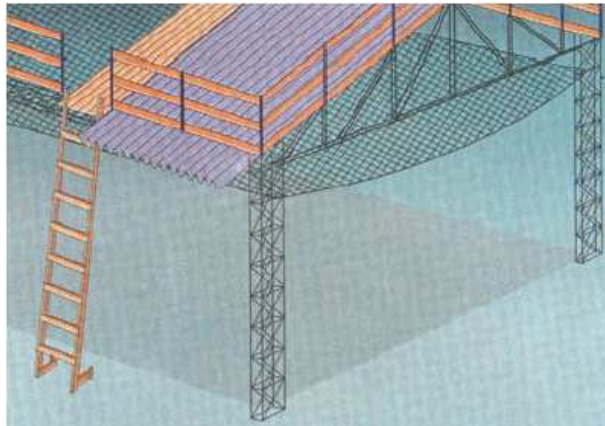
Construção de telhados com a utilização de EPI's e EPC's
